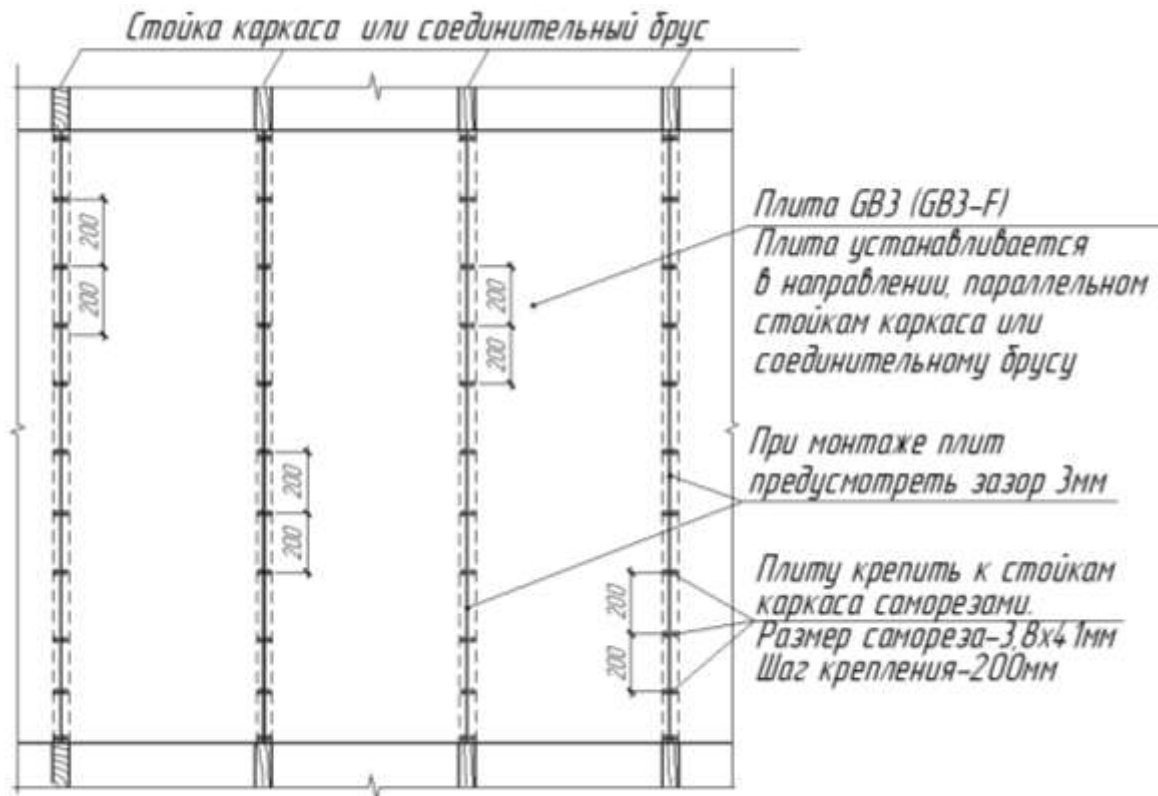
Схема установка плит GB-3F (GB-3) на стойки каркаса вертикально
